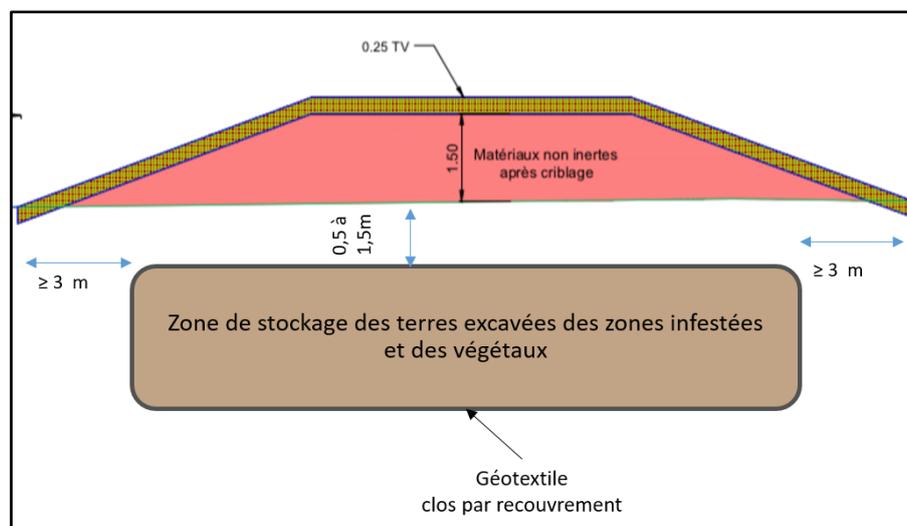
Coupe de principe du merlon de confinement de la Renouée du Japon
